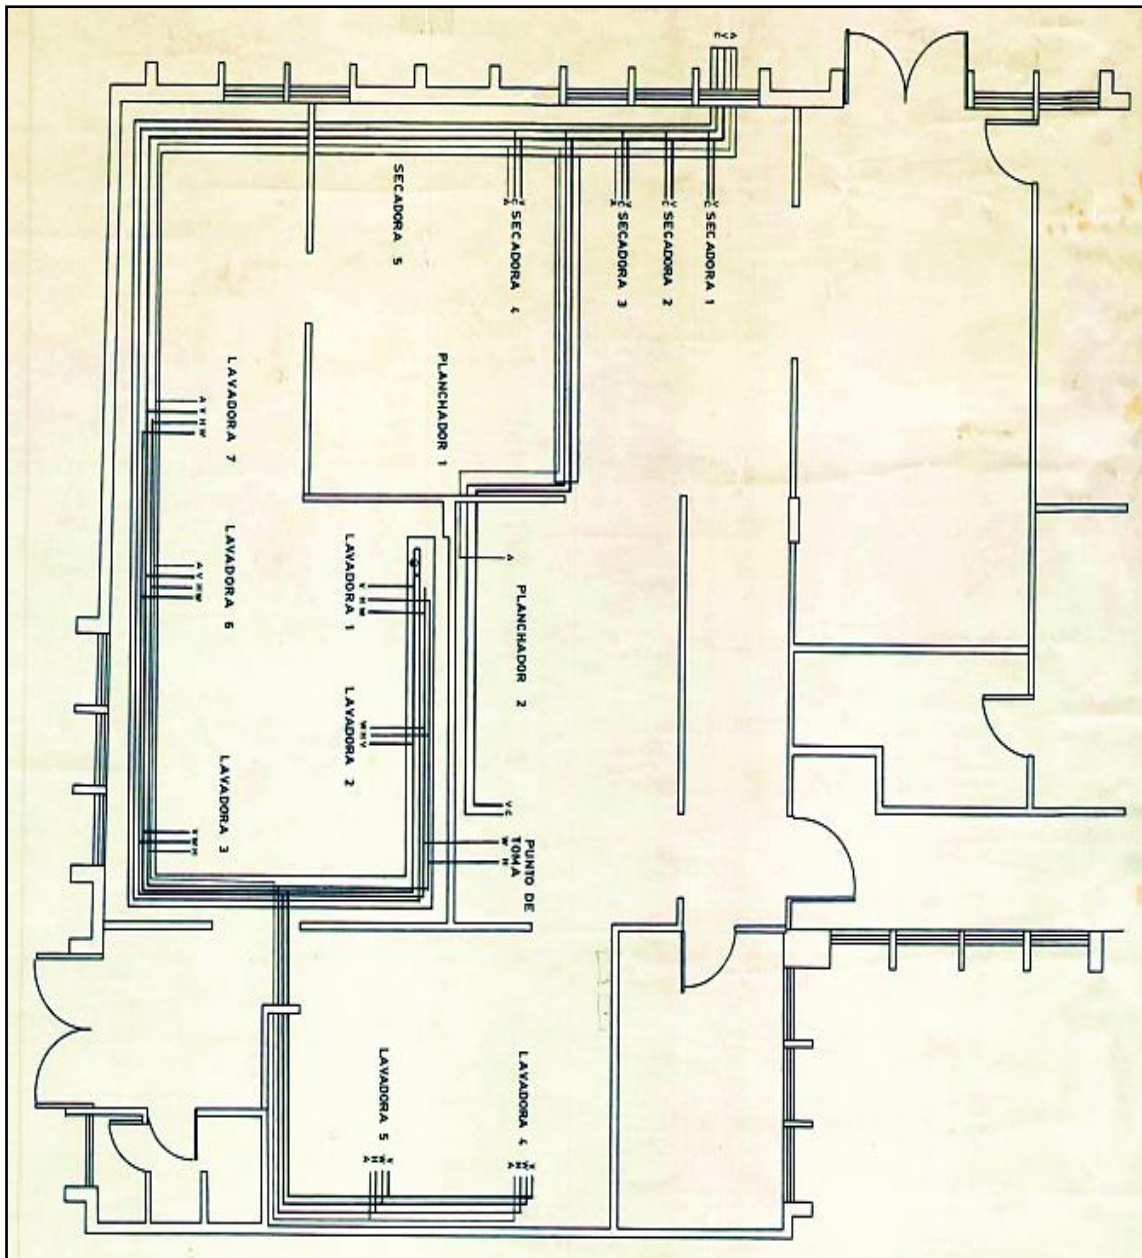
Vista de planta de distribución de obra mecánica en el departamento de lavandería del HNZ.
